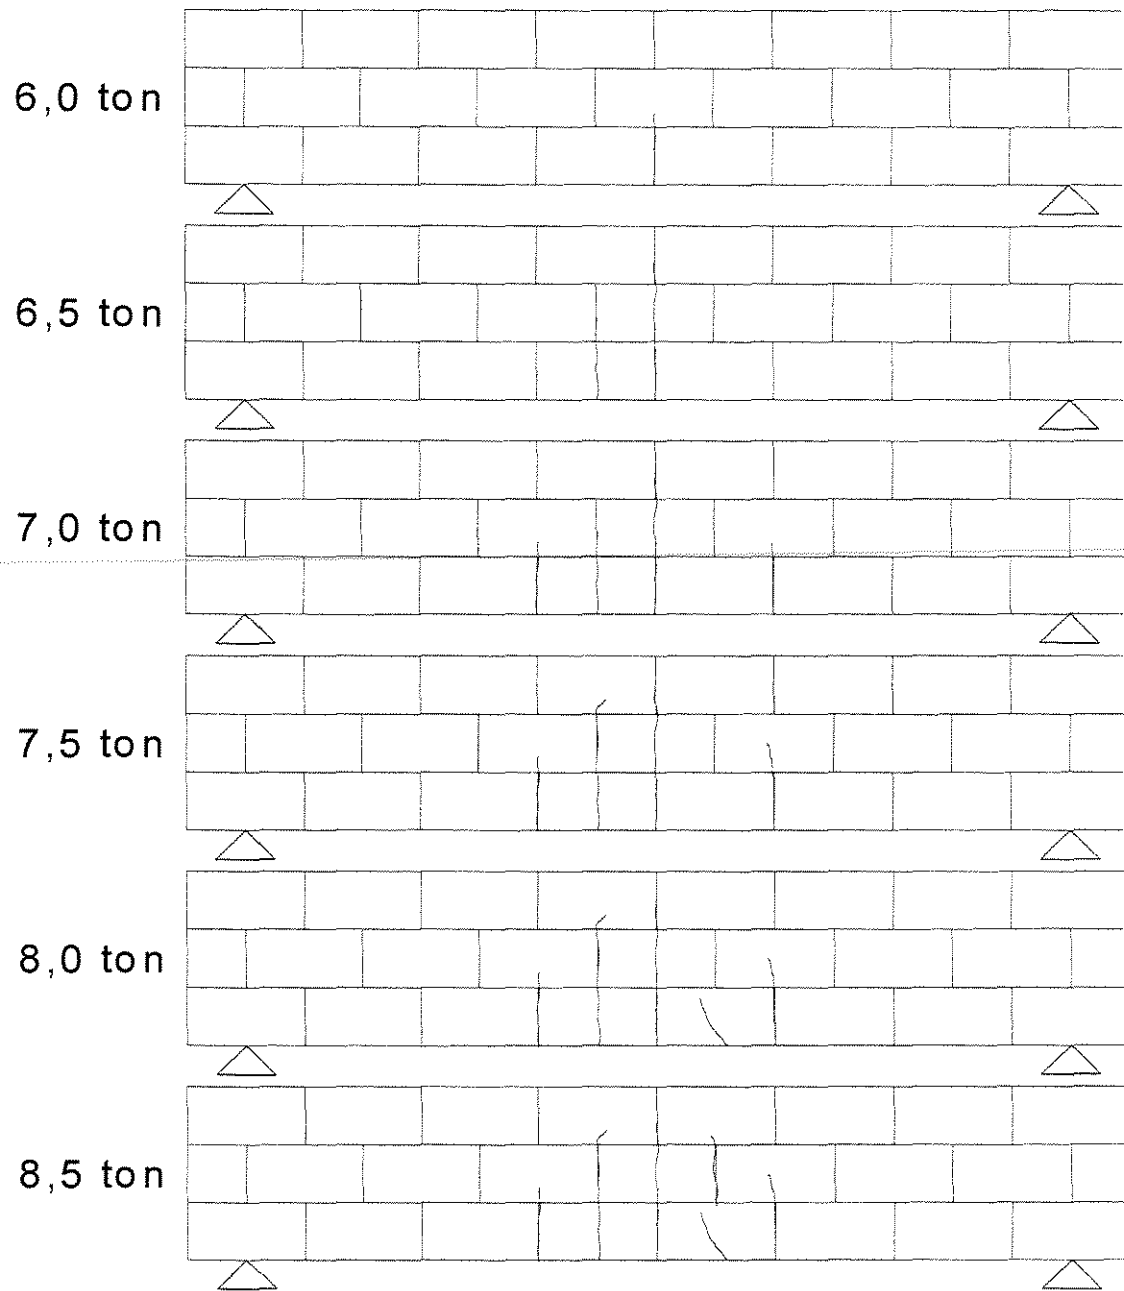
FISSURAS VIGA 3BL-FL
